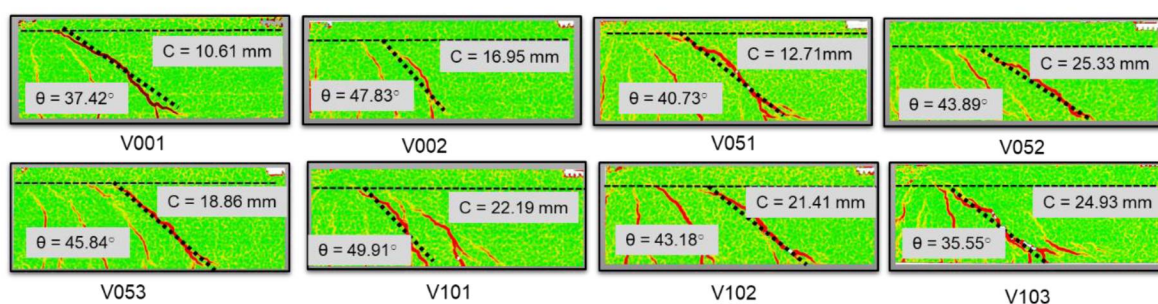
Ângulo da fissura principal e dimensão "c" da altura da zona comprimida das vigas esbeltas
